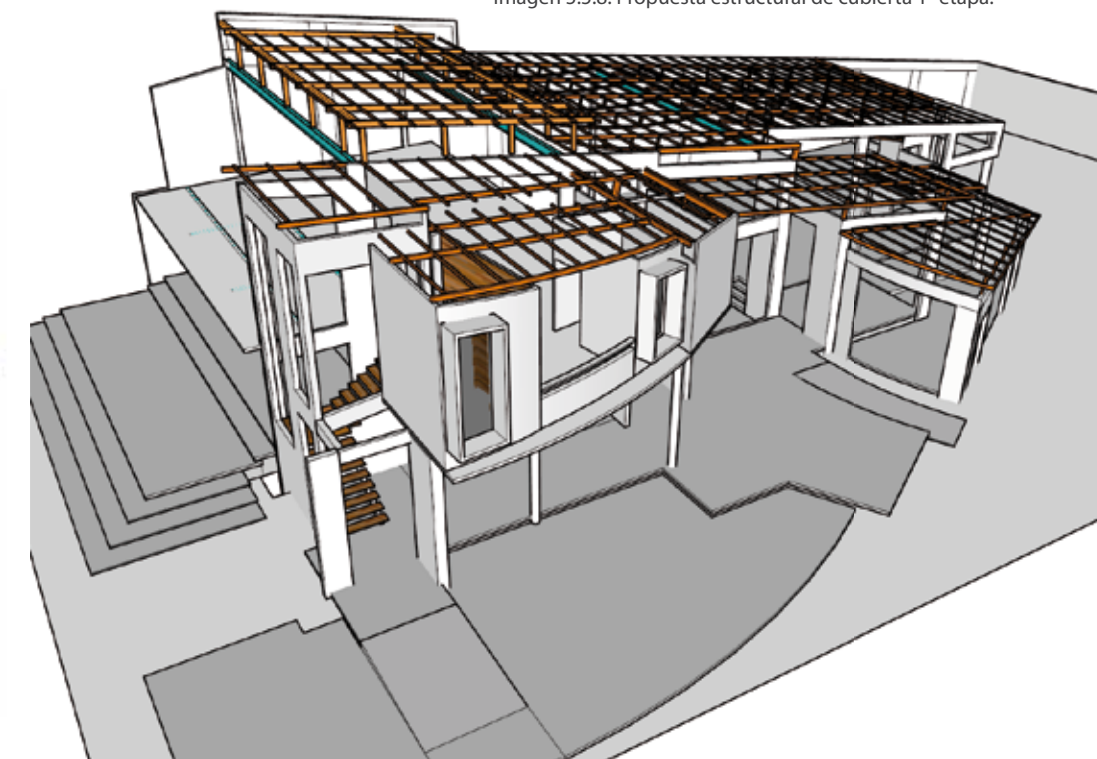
Propuesta estructural de cubierta 1° etapa.
